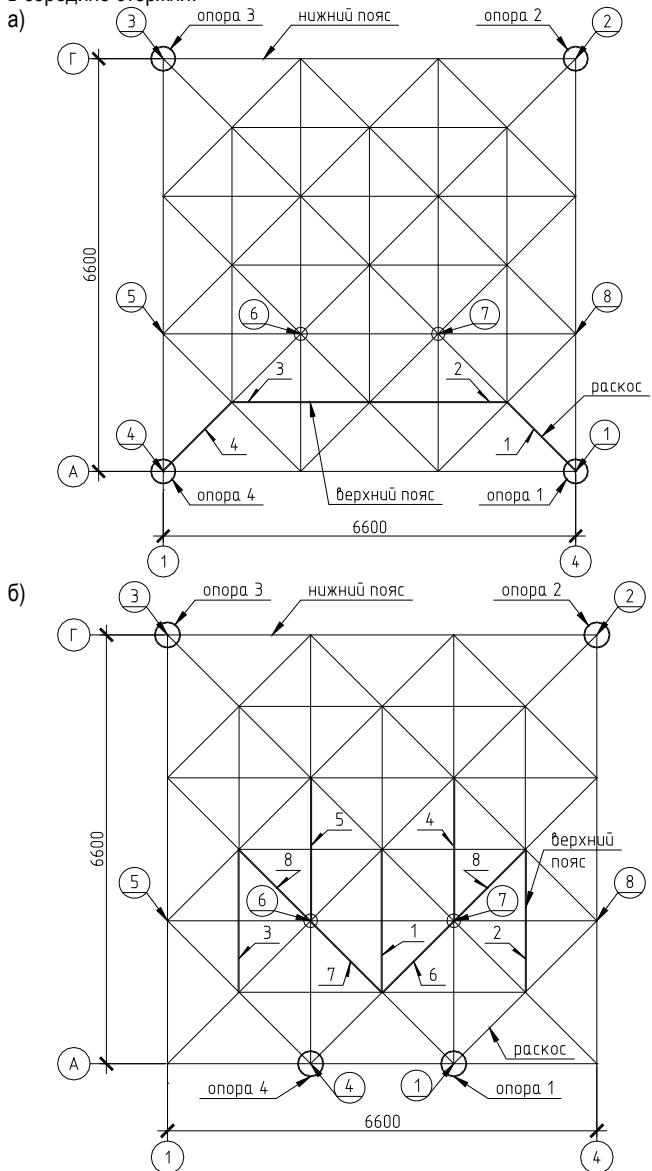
Опирание опытного фрагмента: а) – на четыре крайних узла (вариант I); б) – на два крайних узла и два средних узла (вариант II)
